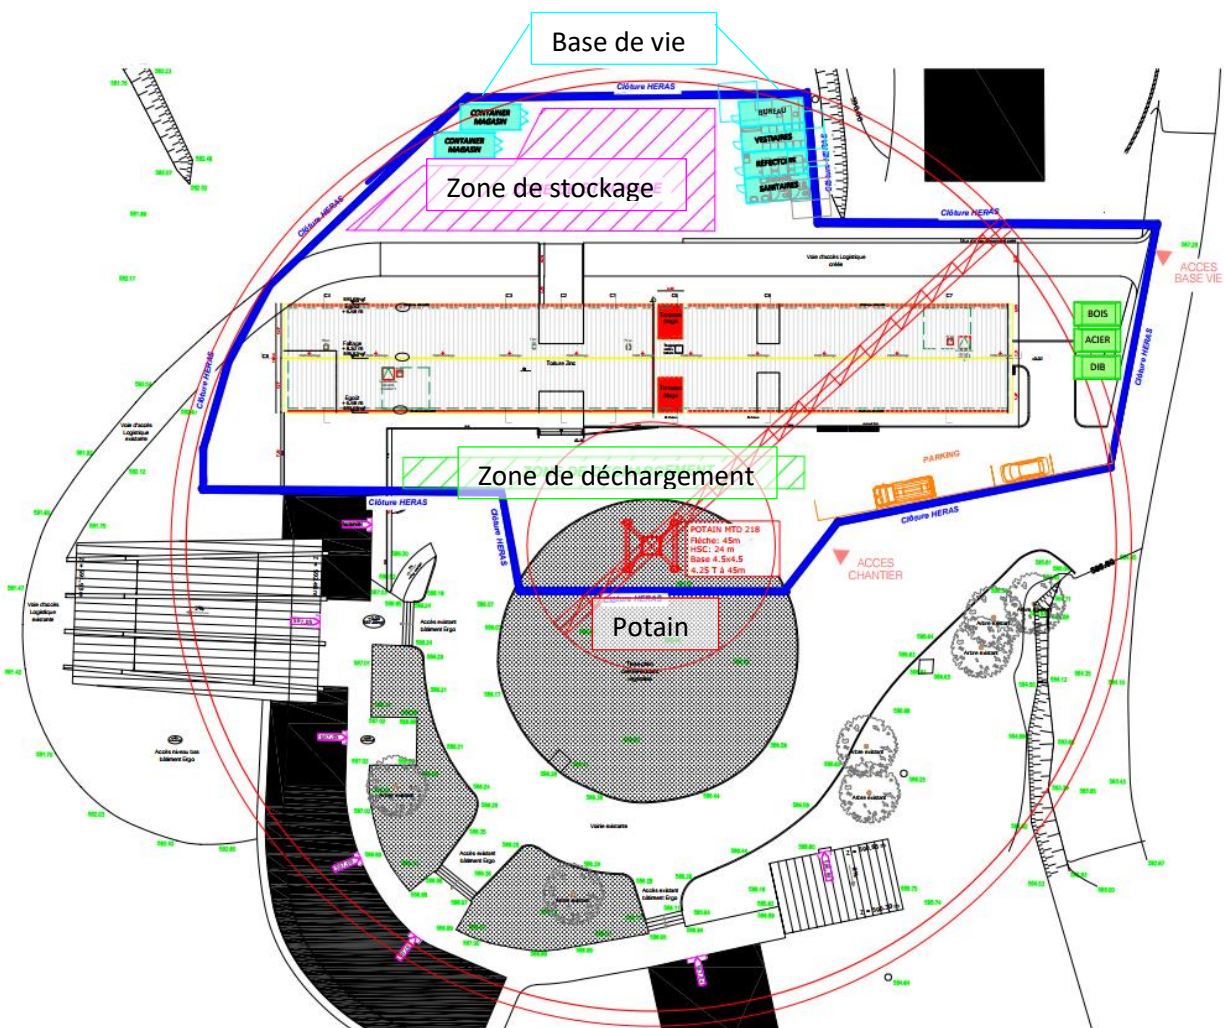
Plan d'installation du chantier du nouveau pavillon psychiatrique
